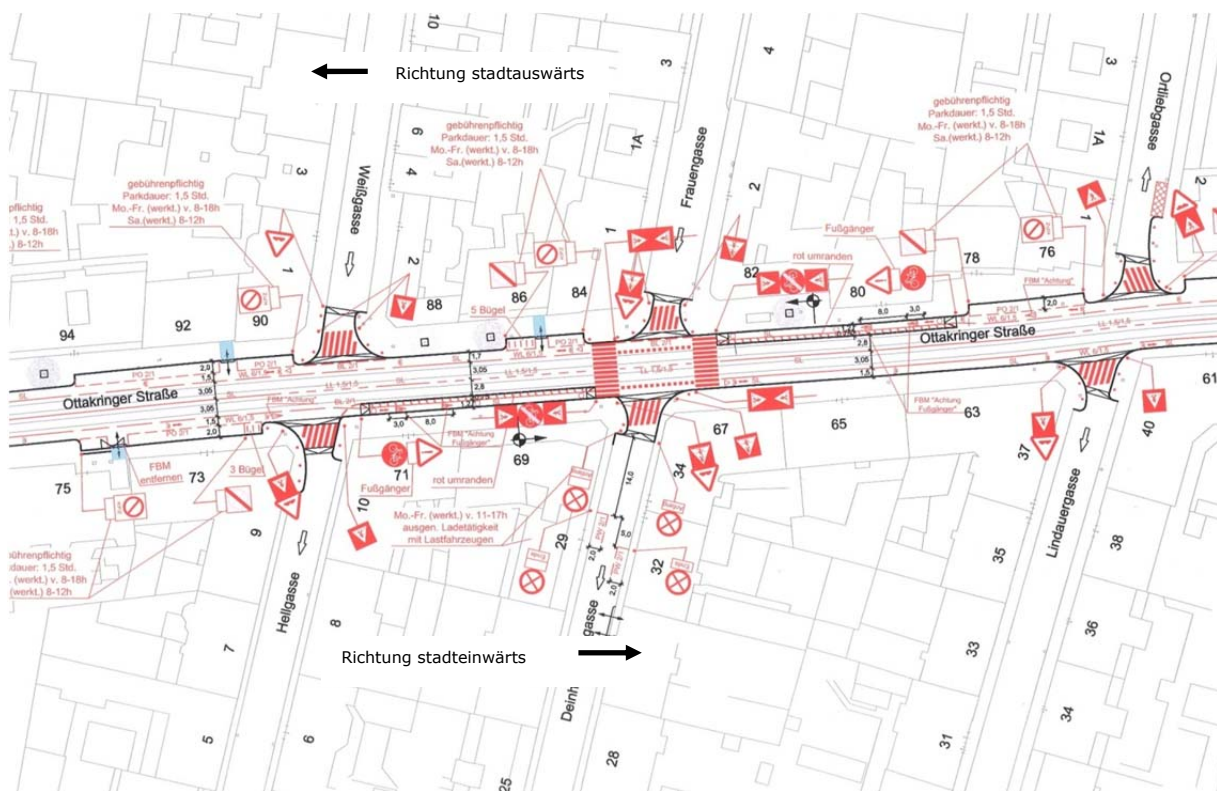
Lageplan Haltestelle Frauengasse.
